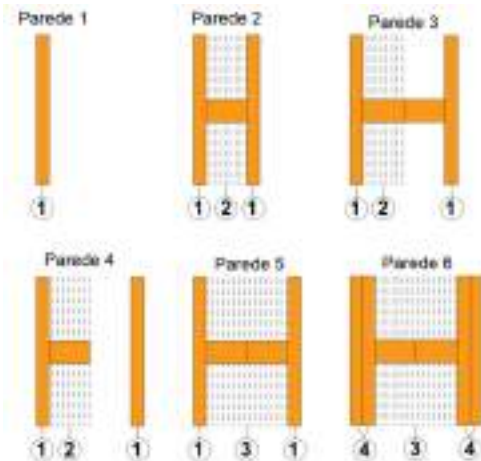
Seção transversal das seis paredes ensaiadas, onde se ilustra esquematicamente as condições de montagem. Materiais: 1 – Uma placa de aglomerado de madeira (15 mm) aparafusado ao barrote de madeira com 50 mm de espessura; 2 - Uma placa de lã mineral (40 kg/m³) com 50 mm de espessura; 3 – Duas placas de lã mineral (40 kg/m³) com 50 mm de espessura; 4 – Duas placas de aglomerado de madeira (15 mm) aparafusadas ao barrote de madeira.
